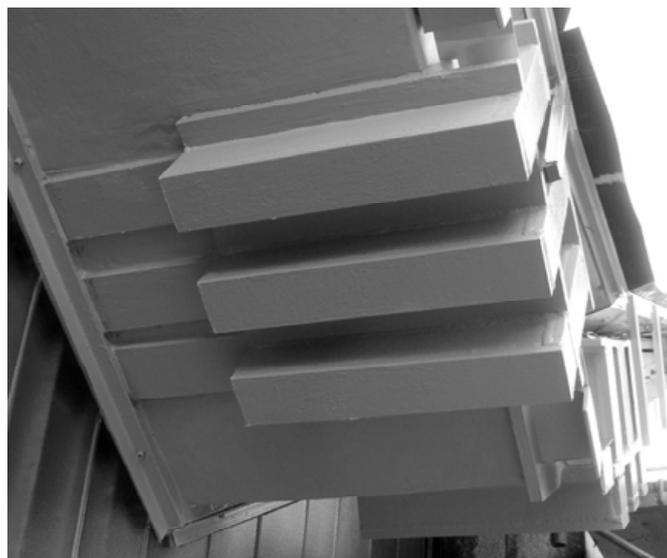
Fertiggestellte Verankerung mit Anschluss der durch die Fassade hindurch geführten Stahllamellen an das Verankerungselement und F 30 – Anstrich
